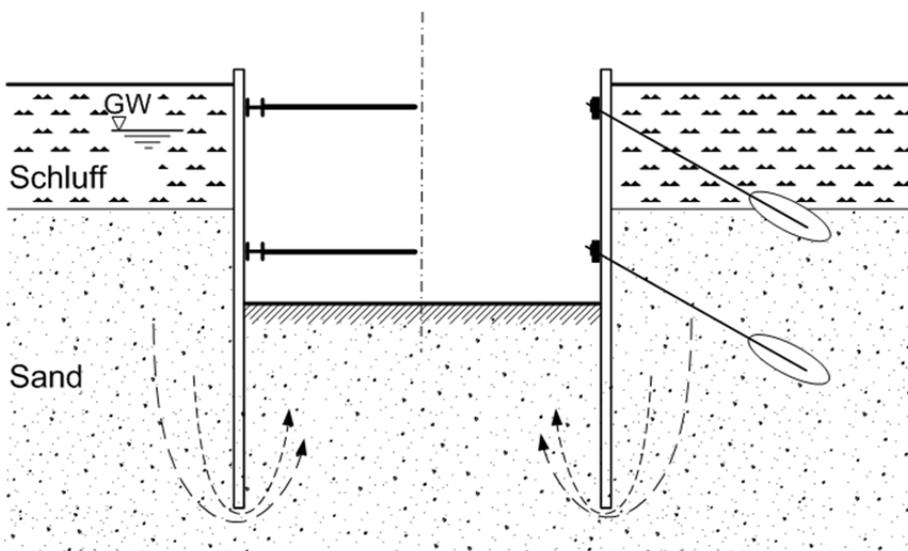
Baugrube im Grundwasser - Einbindung der Baugrubenumschließung
